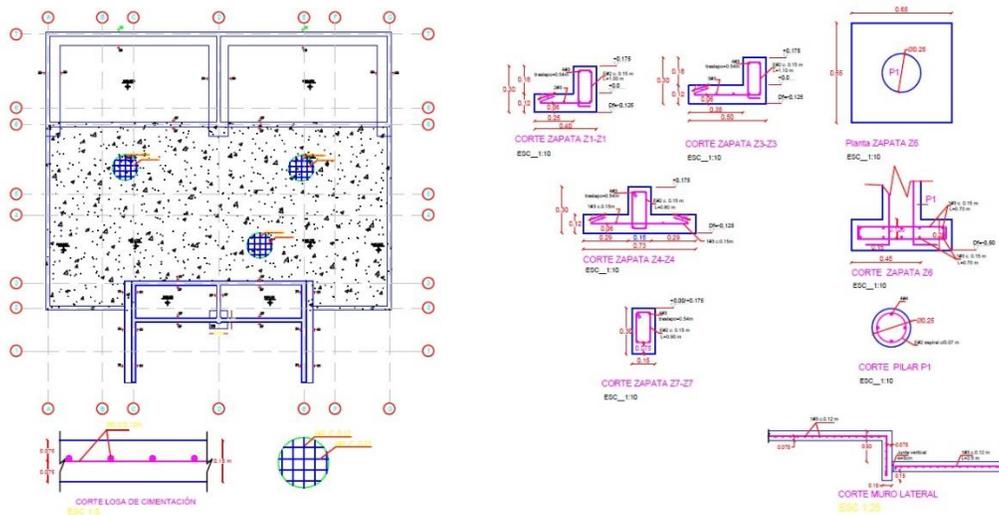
Diseño Estructural, Losa de cimentación. Fuente Diseño Ing. Carlos Ariel Hurtado.
